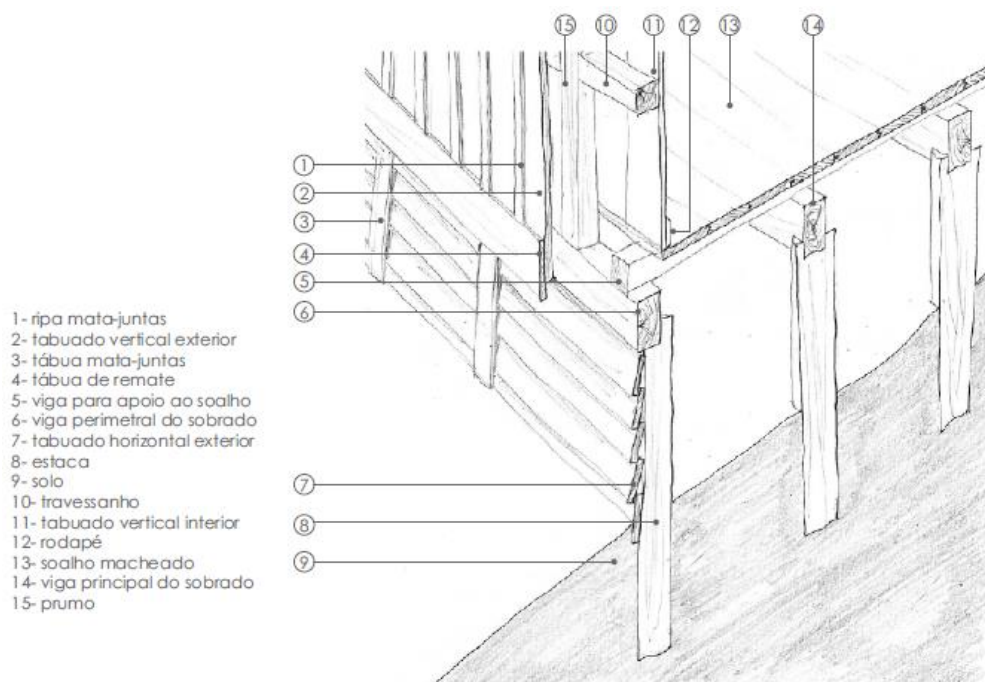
Pormenor tipo de fundação pós-permeável com a mesma fundação do permeável tipo 4 (fonte: Moutinho (2007))
